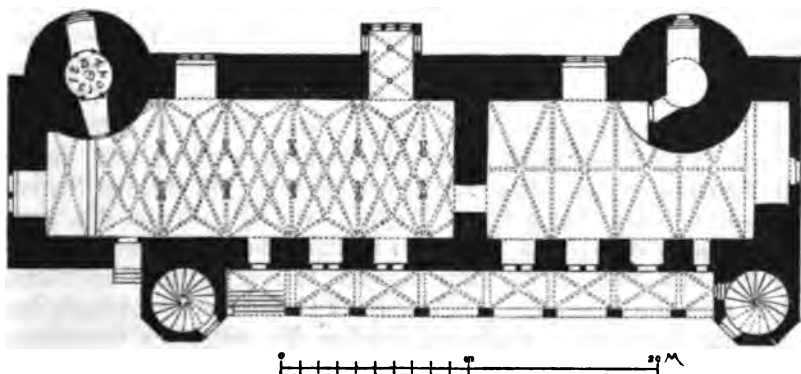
Schloss zu Offenbach. Grundriss.
